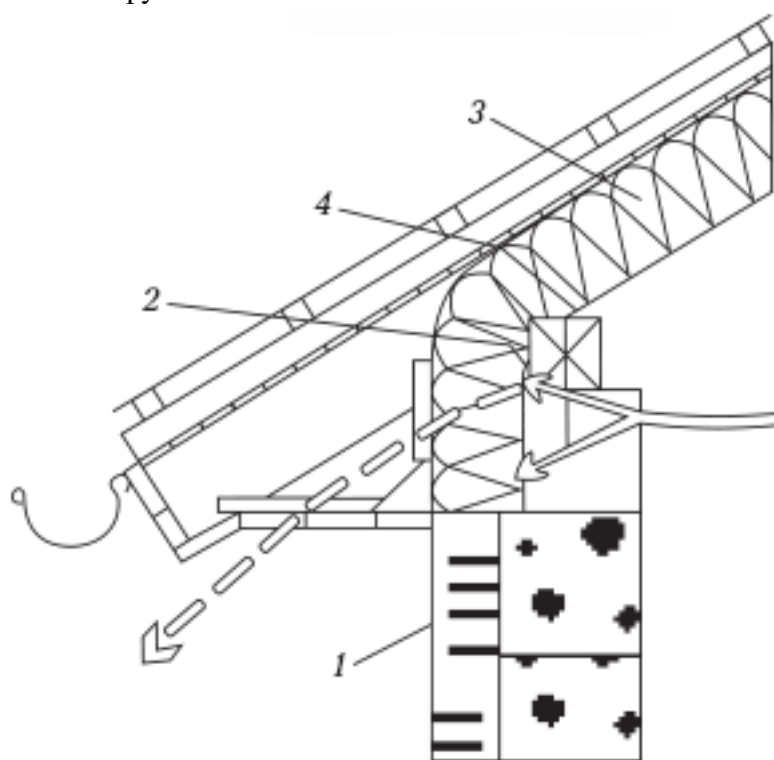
Изоляция примыкания коленчатой стенки к крыше: 1 – утеплитель стены; 2 – мауэрлат; 3 – утеплитель крыши (минвата); 4 – место, где нельзя обрывать утеплитель
